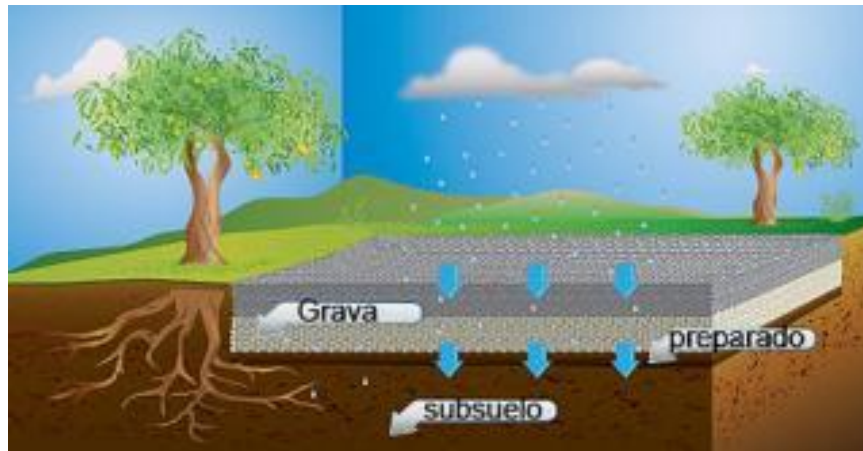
Capas estructurales del concreto poroso. Fuente: (Ekeco, 2009)
